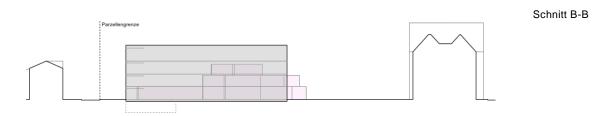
Variante Ersatzneubau Gartenschulhaus – Schnitt B-B
